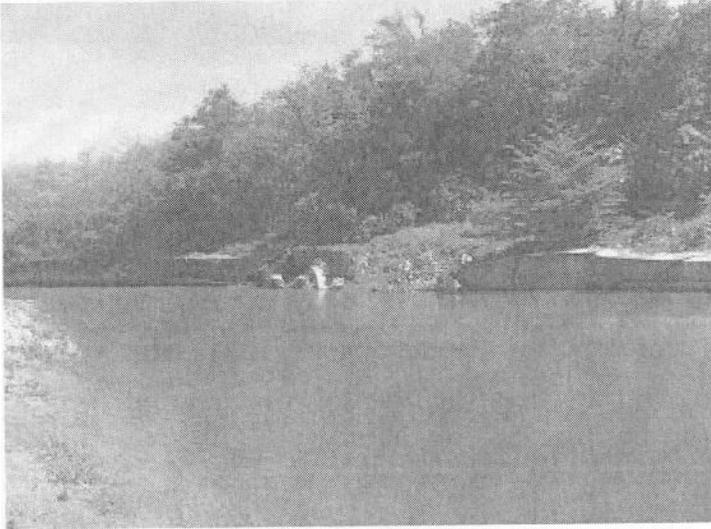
y 4. Sitio No 2 proyectado para la construcción de gaviones
